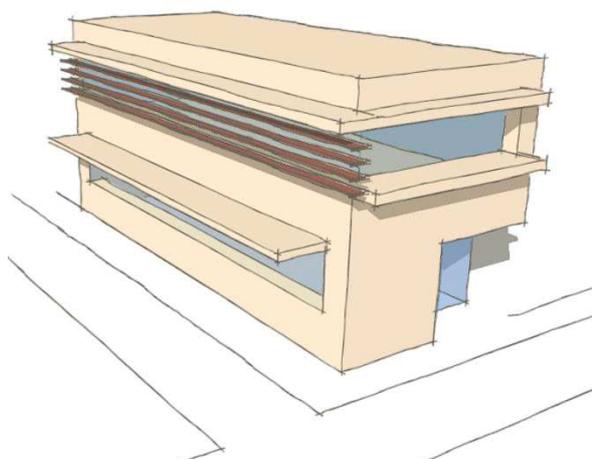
Parasoles horizontales sobre fachada Norte.
